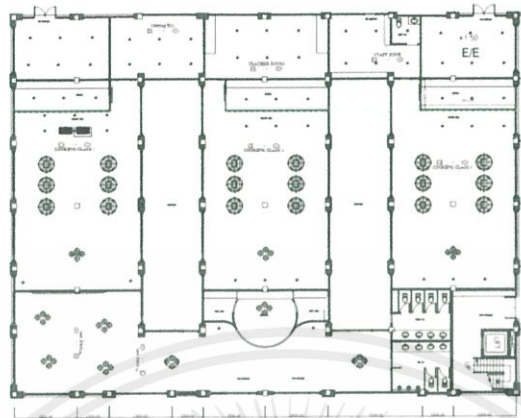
แสดงผังฝ้าเพดานของ Bar and Restaurant 1<sup>st</sup> Floor
